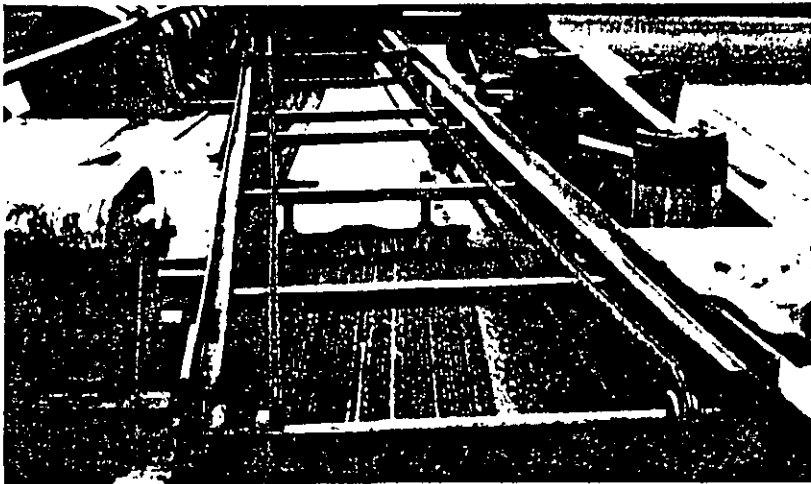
Máquina productora de una textura burda en el hormigón recién pavimentado.
